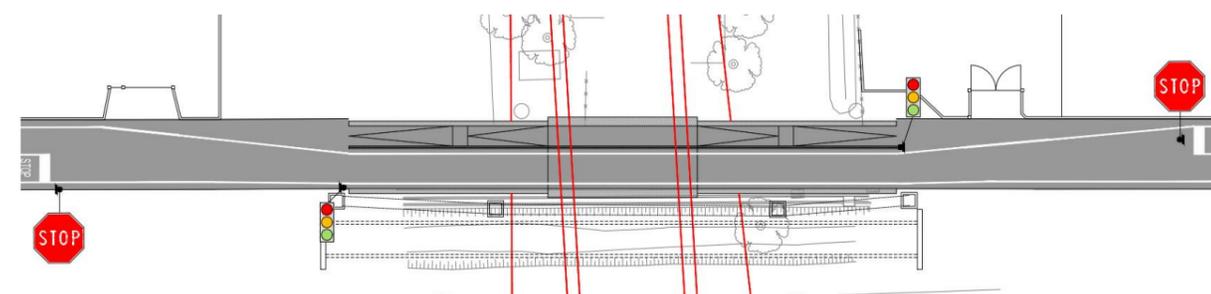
Dettaglio planimetrico del sottopasso con senso alternato (dalla tavola di progetto 1370.0.F.E.008.2.D.0_Sottopasso via Colombo).
